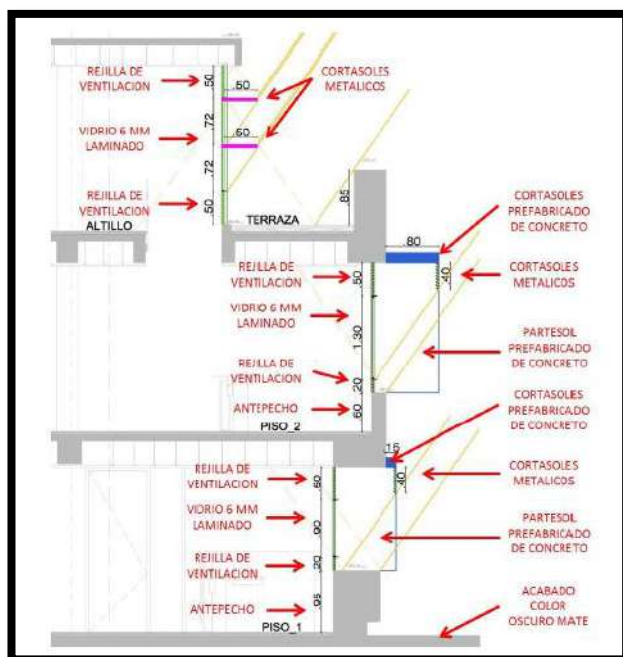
SISTEMA CONSTRUCTIVO EN FACHADA
